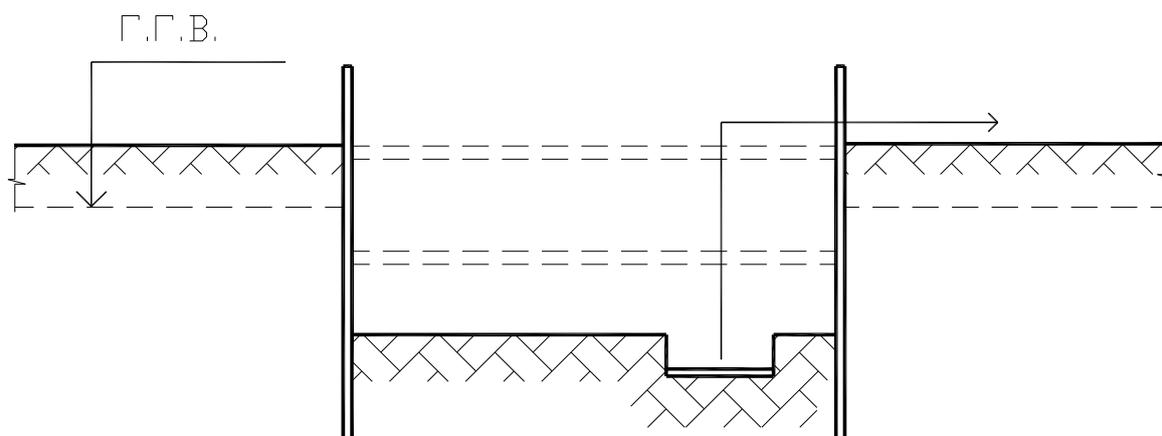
Открытый водоотлив с откачкой воды насосами в оплывающих неустойчивых грунтах, при креплении откосов
